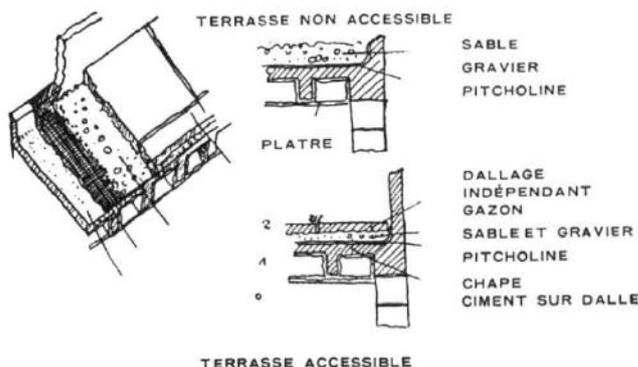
Detalle de la cubierta plana transitable de Le Corbusier y dos secciones constructivas de dos cubiertas, una no transitable de grava y la otra transitable con losetas de hormigón.
